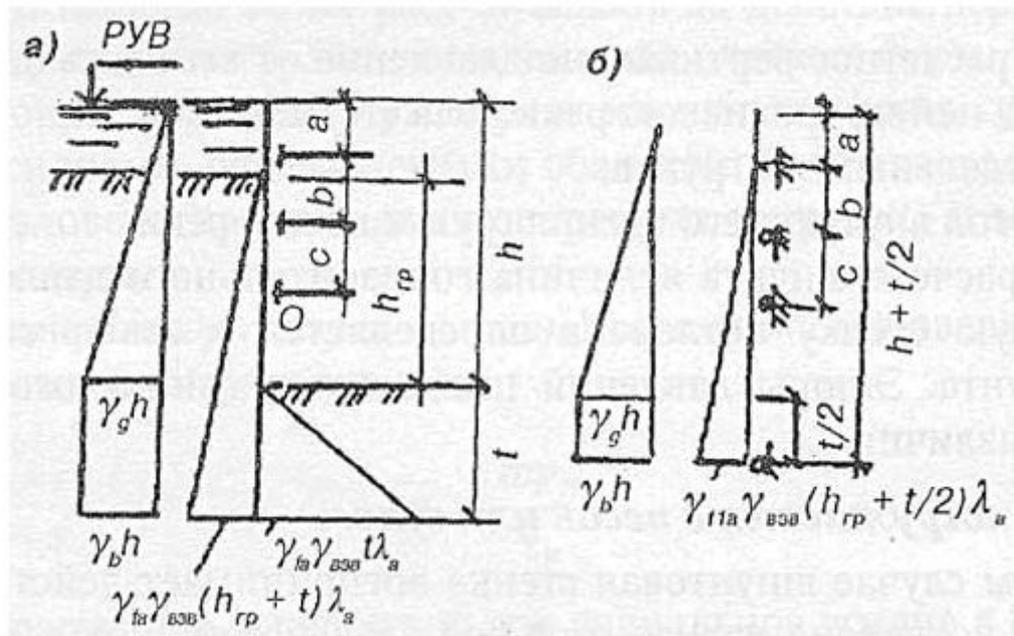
Схемы расчета шпунтового ограждения в песчаных грунтах с тремя ярусами креплений: а – эпюры давления грунта; б – расчетная схема
